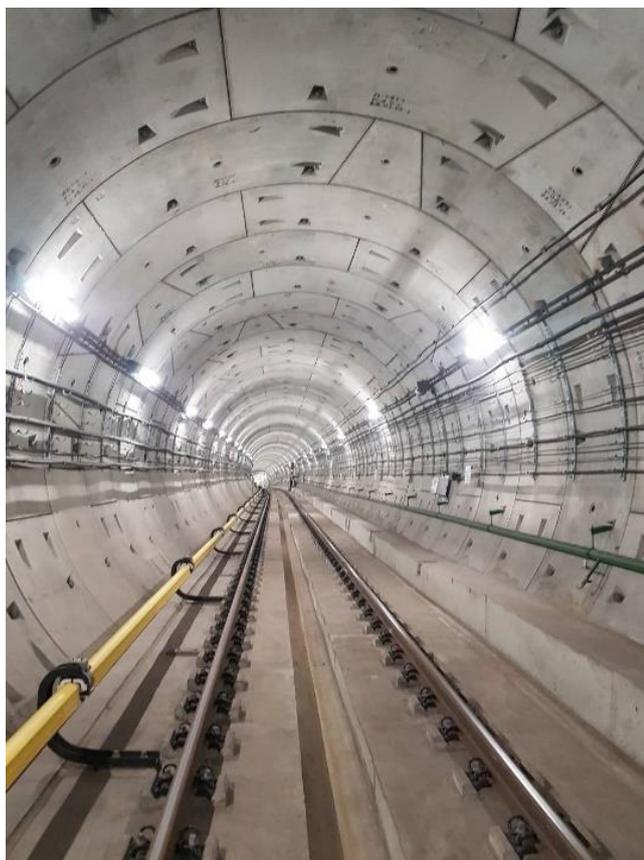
Перегонный тоннель из железобетонных тубингов высокоточной тоннельной обделки
